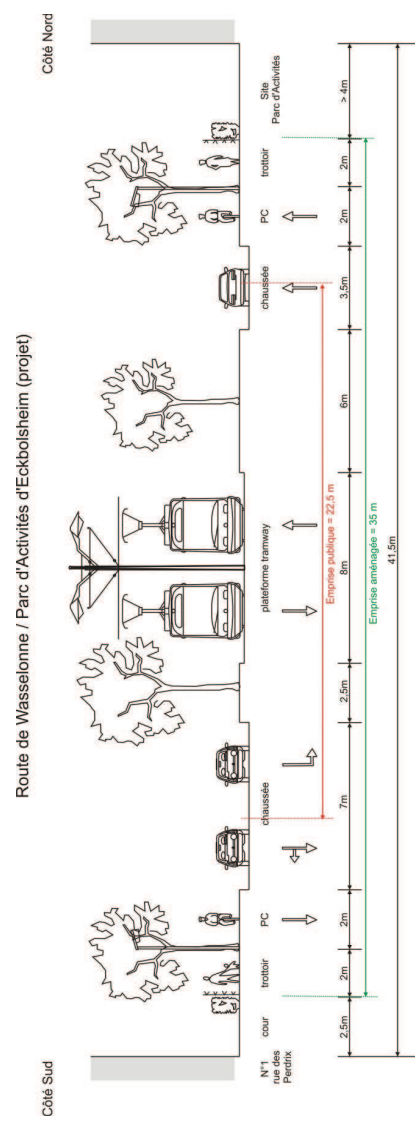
Aménagement projeté - coupe 18 (route de Wasselonne)
